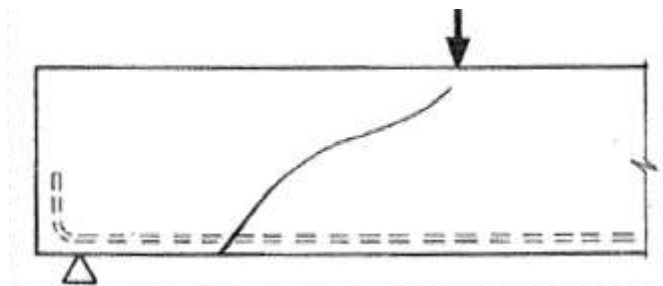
Fisuras producidas por la fuerza de corte en el caso de cargas concentradas
